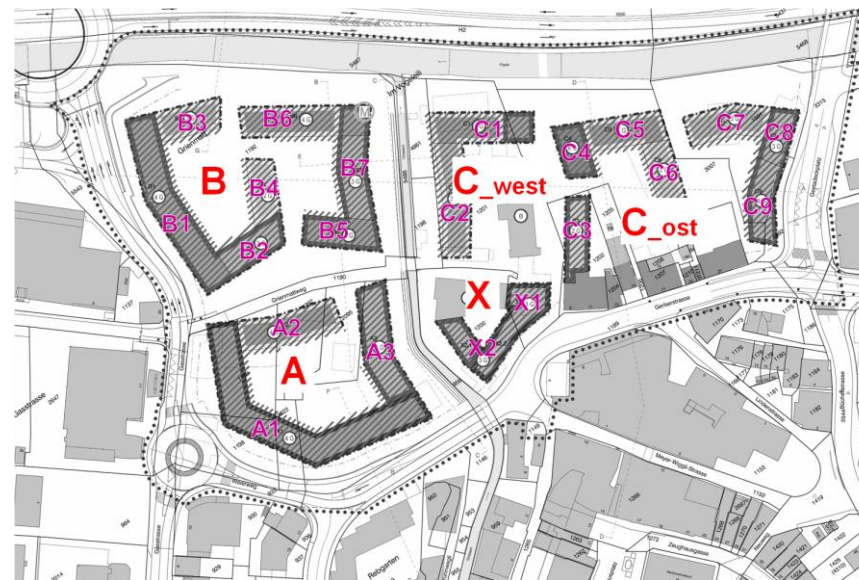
Teilgebiete Masterplan (rot) und Gebäudenummerierung (rosa)
